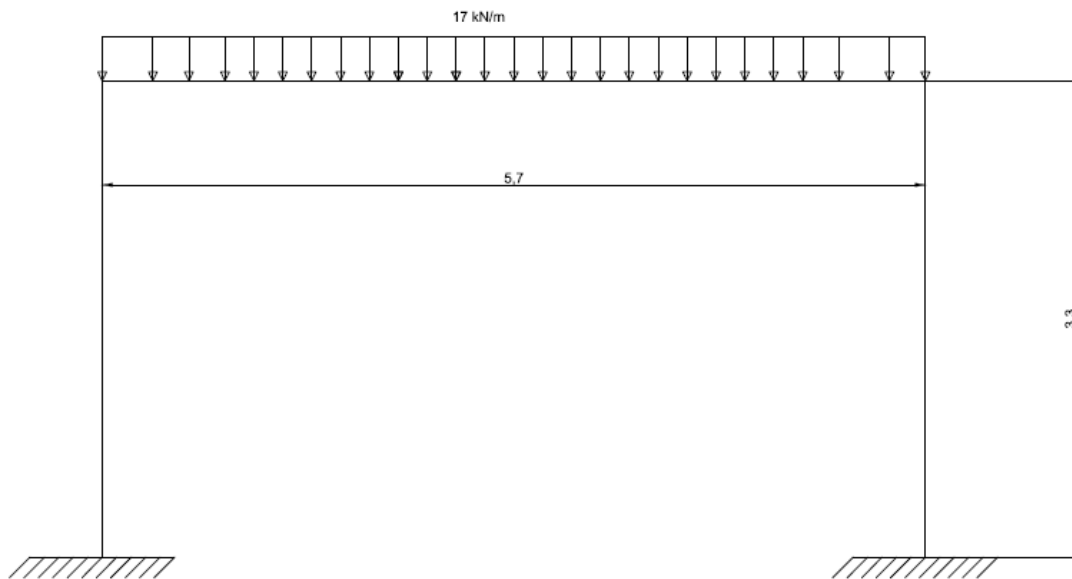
Pórtico de la estructura portante de la cámara de canales (alzado).
